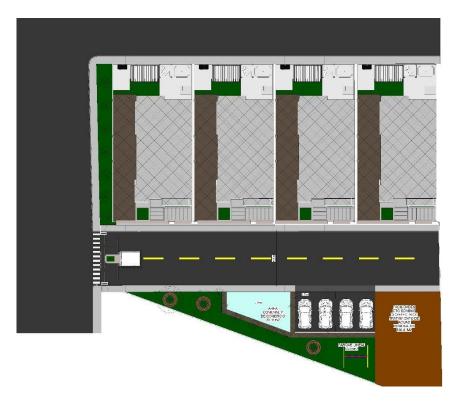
Vista en planta del plan masa de la urbanización propuesta. (Elaboración propia archivo RVT).
